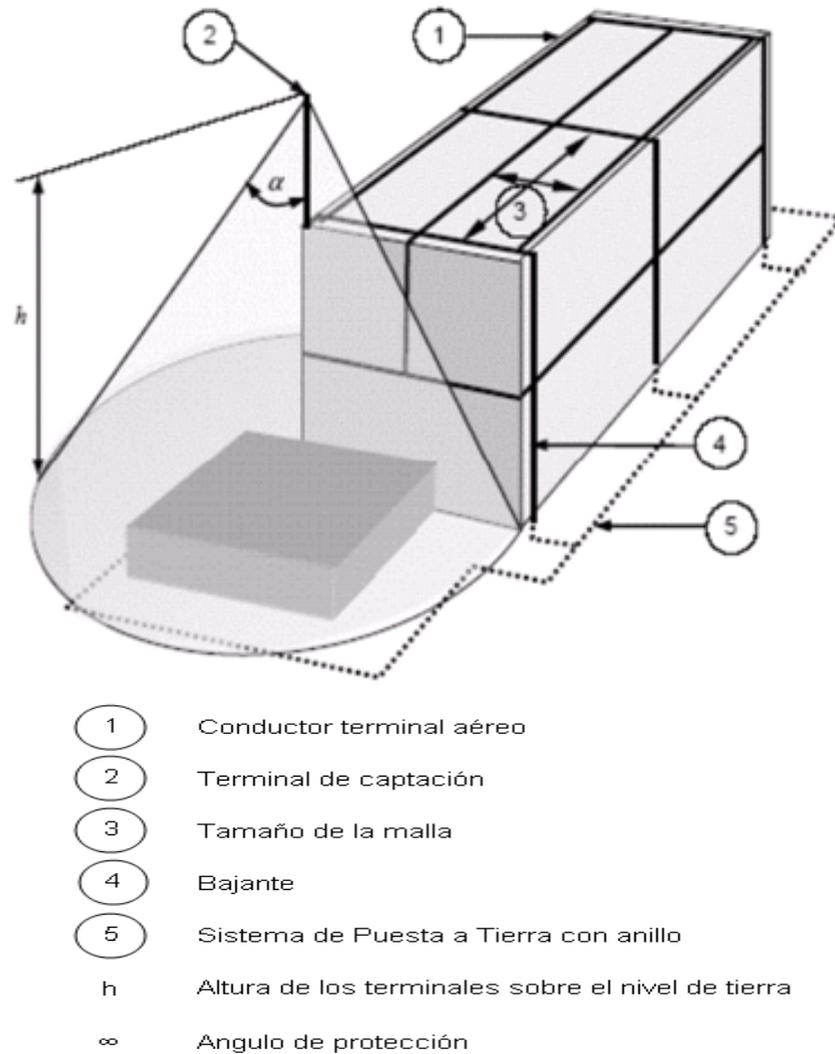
Elementos que componen un Sistema de Apantallamiento y su Protección Externa
